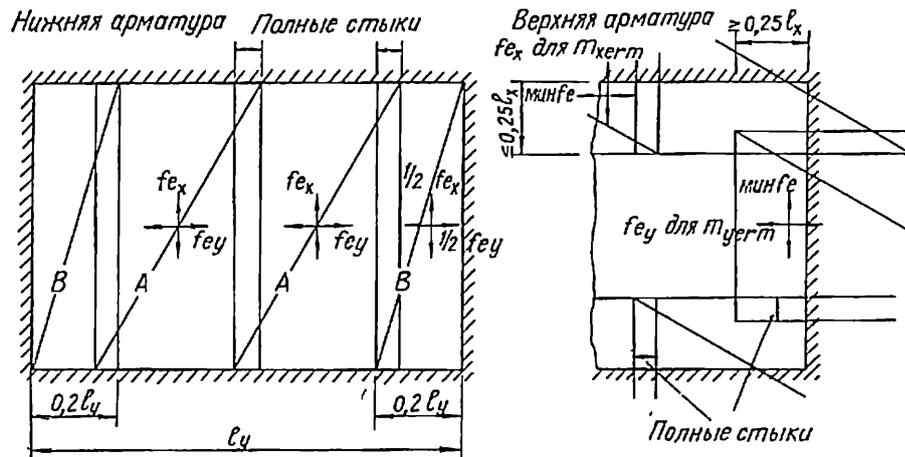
24в. Армирование сетками защемленной по контуру прямоугольной плиты (равномерно распределенная нагрузка)
